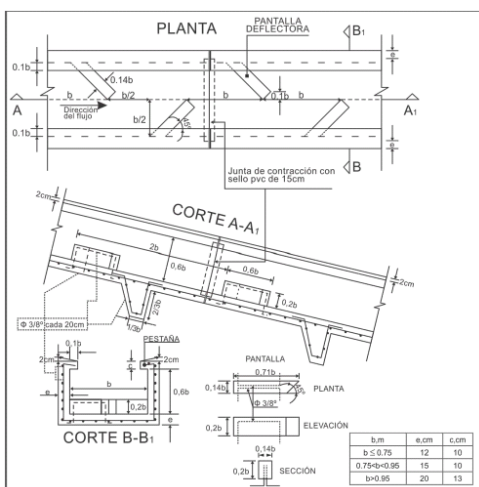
Detalle típico y refuerzo estructural sugerido para el CRTC
